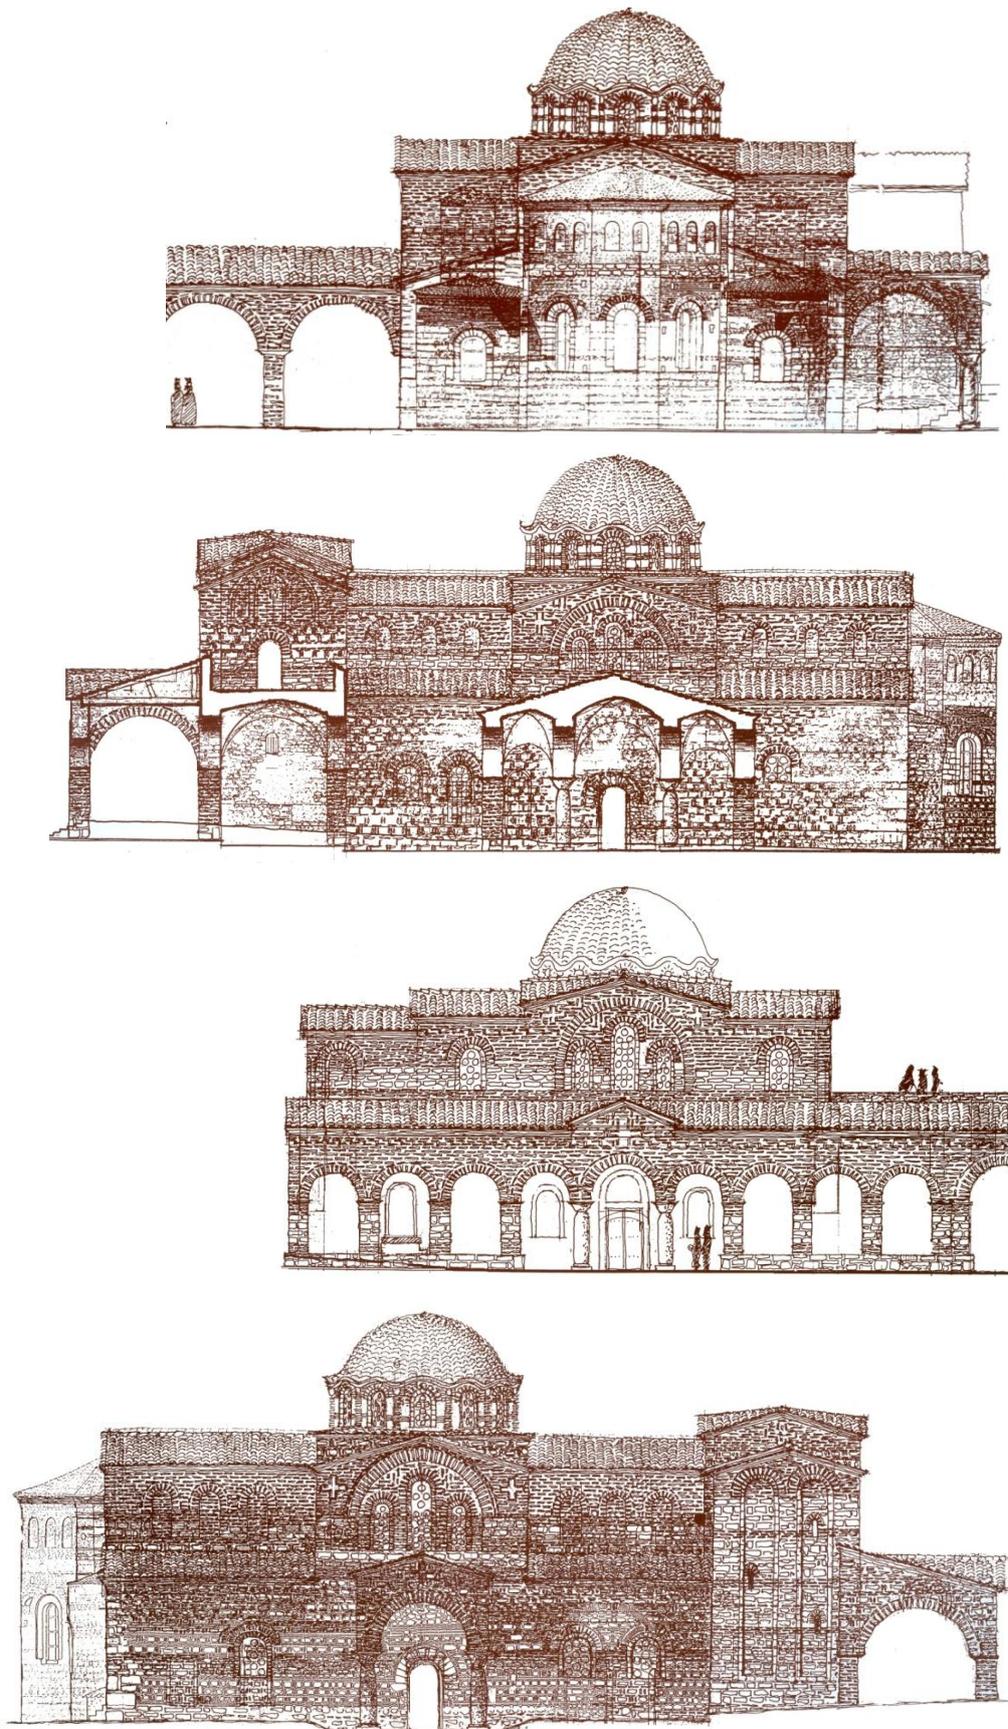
La catedral de Santa Sofía hacia la mitad del s. XI, con las fases de Samuel y León completas. Alzados este, sur, oeste y norte. Reconstrucción según Boris Chipan.
